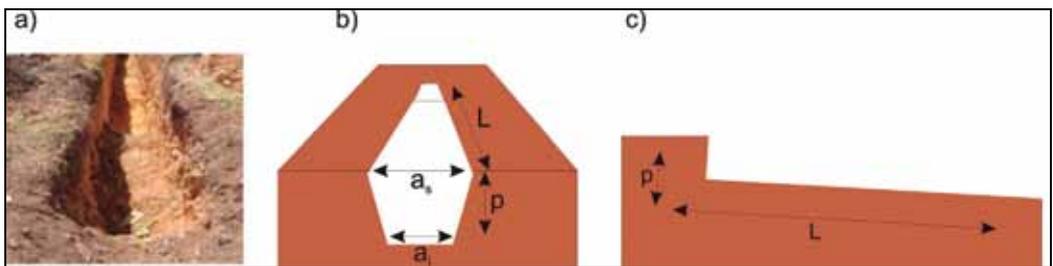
Cavado de la zanja, a) Fotografía del surco, b) Vista frontal, c) Vista lateral. Ancho superior (a_s), ancho inferior (a_i), profundidad (p) y longitud (L).
